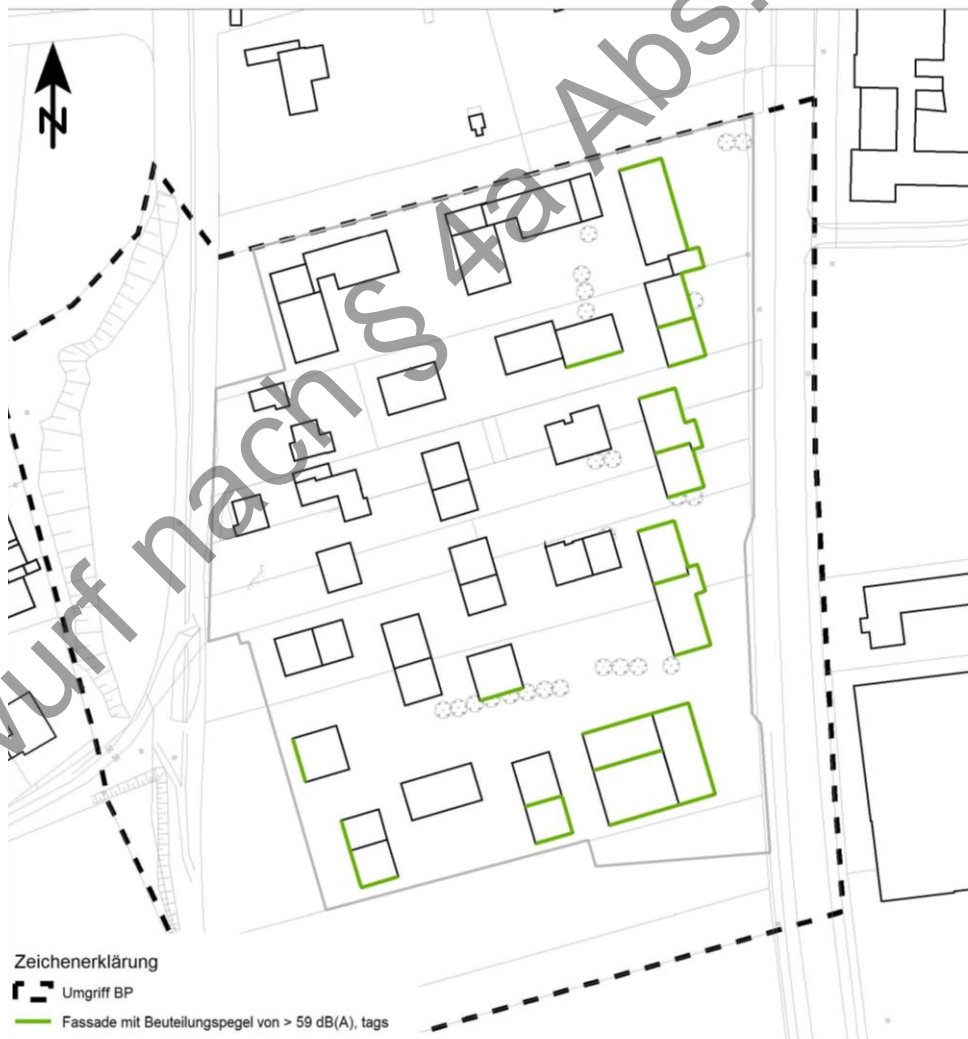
Lageplan betroffene Fassaden Verkehrslärm
